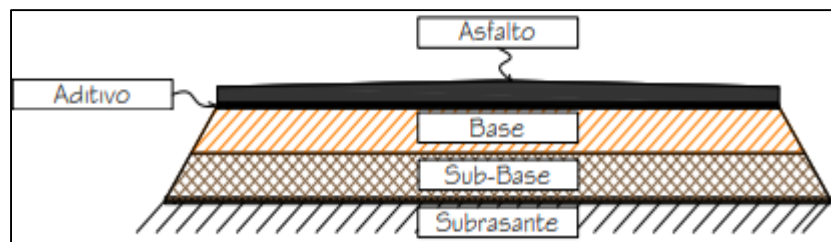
Sección Transversal del Pavimento Semi Rígido
